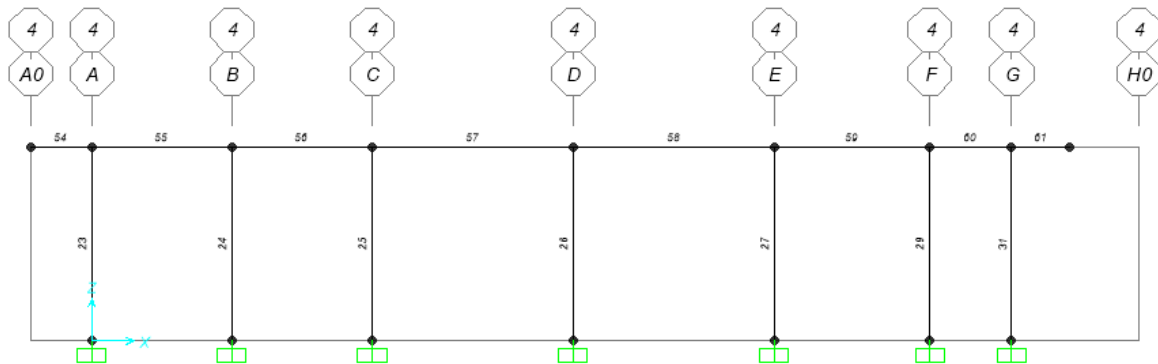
Vista in pianta modello struttura in elevazione – Piano 1 z = 4,15 - numerazione elementi frame e joint
